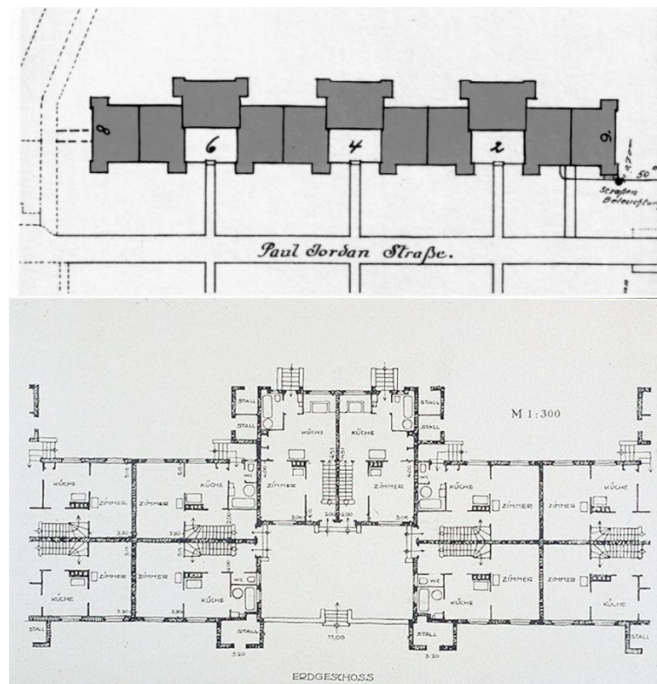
P. Behrens, AEG-Siedlung *Henningsdorf*, Lageplan und Grundriss
